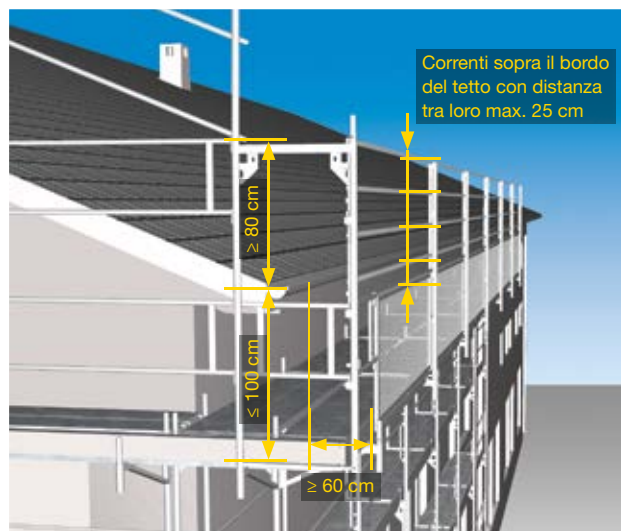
ponte da lattoniere con parete di protezione da copritetto, variante con correnti sopra il bordo del tetto
